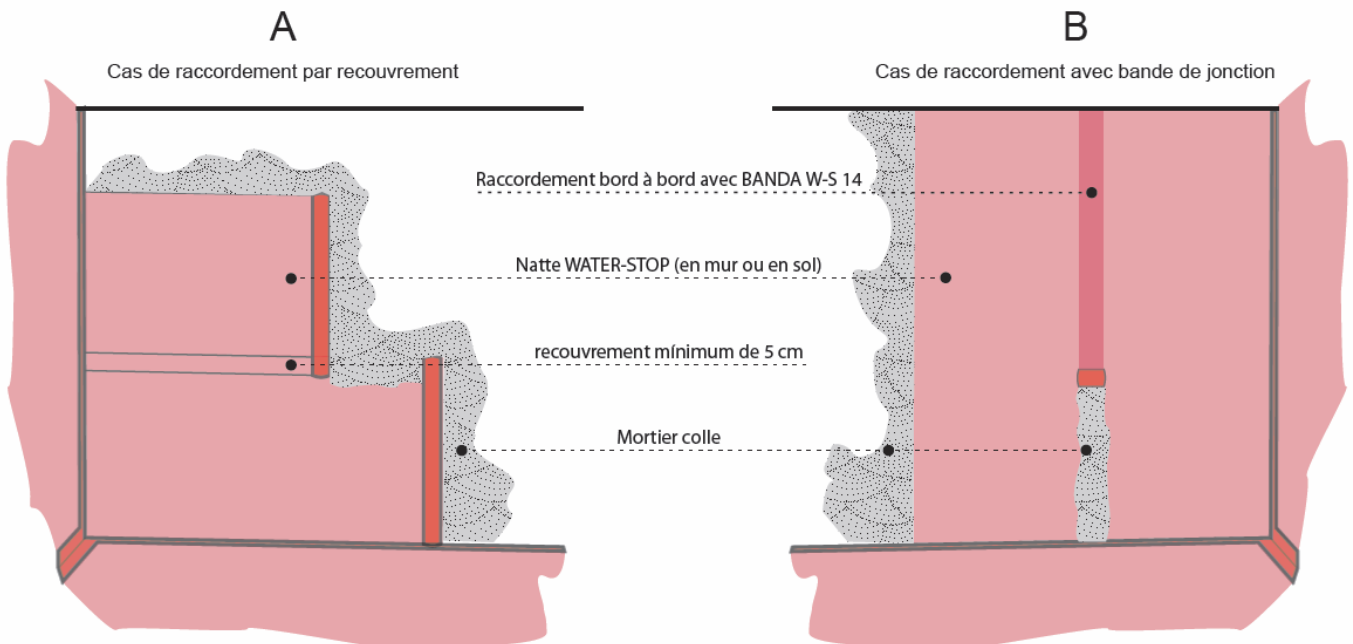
Traitement des jonctions entre 2 lés de sous couche WATER STOP (Cas A : jonction par recouvrement des lés de sous couche ; Cas B : jonction par recouvrement avec la bande BANDA W-S 14)
